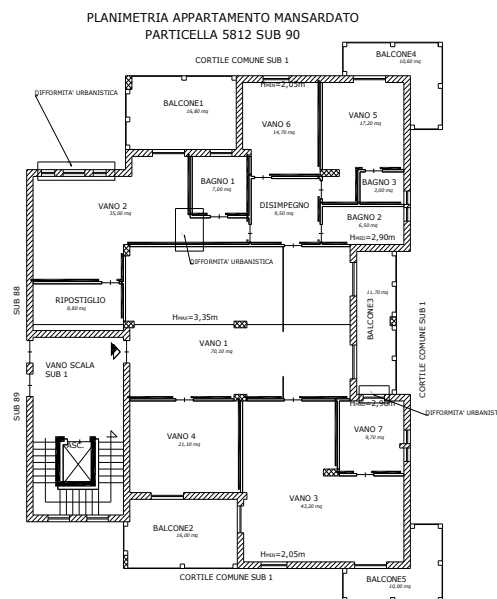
planimetria con le difformità urbanistiche dell'appartamento mansardato al quinto piano
